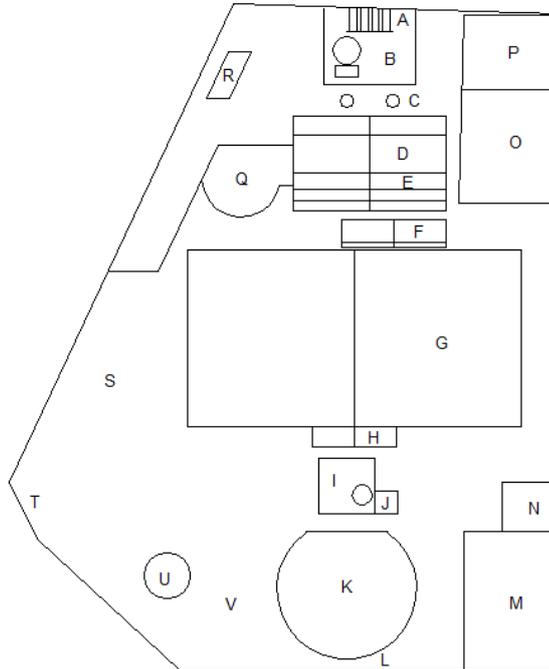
Seccionamiento de toda la Planta según los planos proporcionados por la Junta Fuente: Autor
